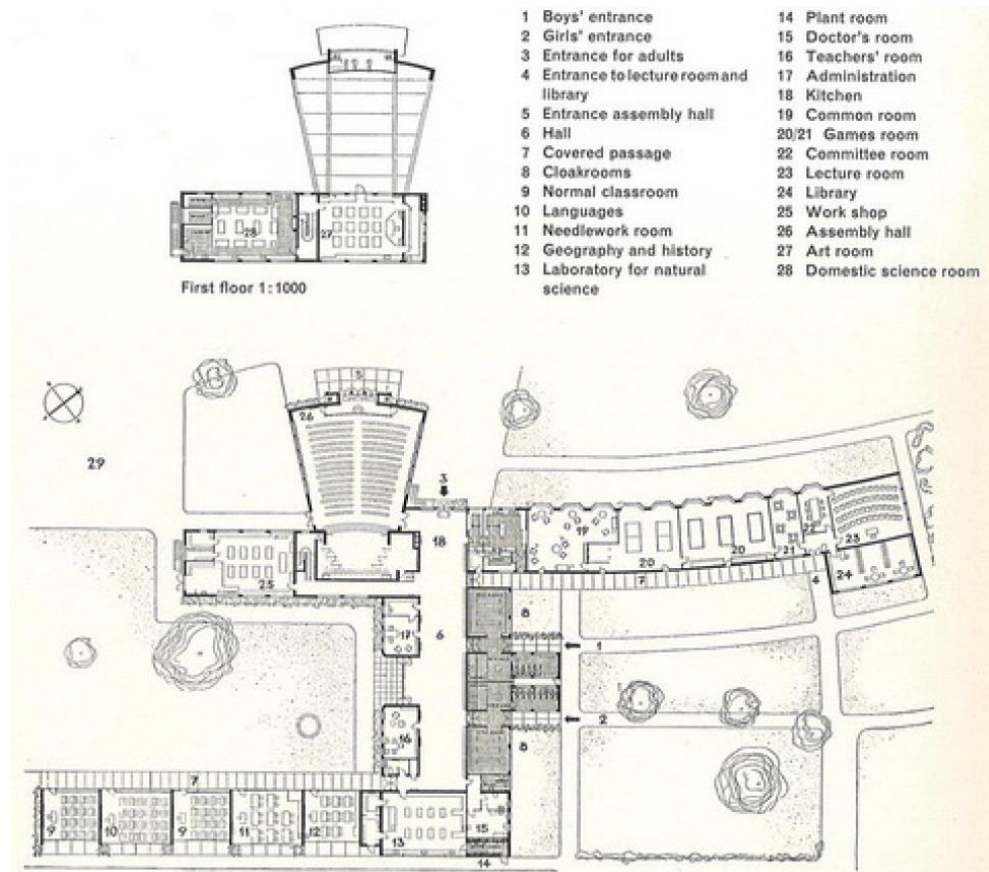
Planta baja y primera del del Impington Village College. (Gómez Alfonso 2015, 188)
